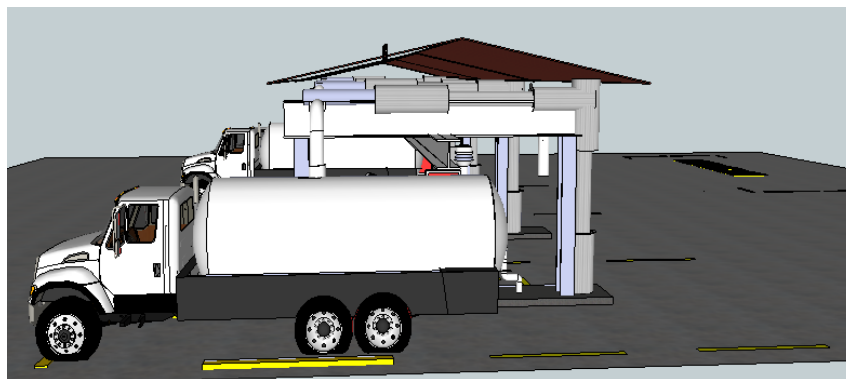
Islas vista lateral (instalaciones modificadas)
